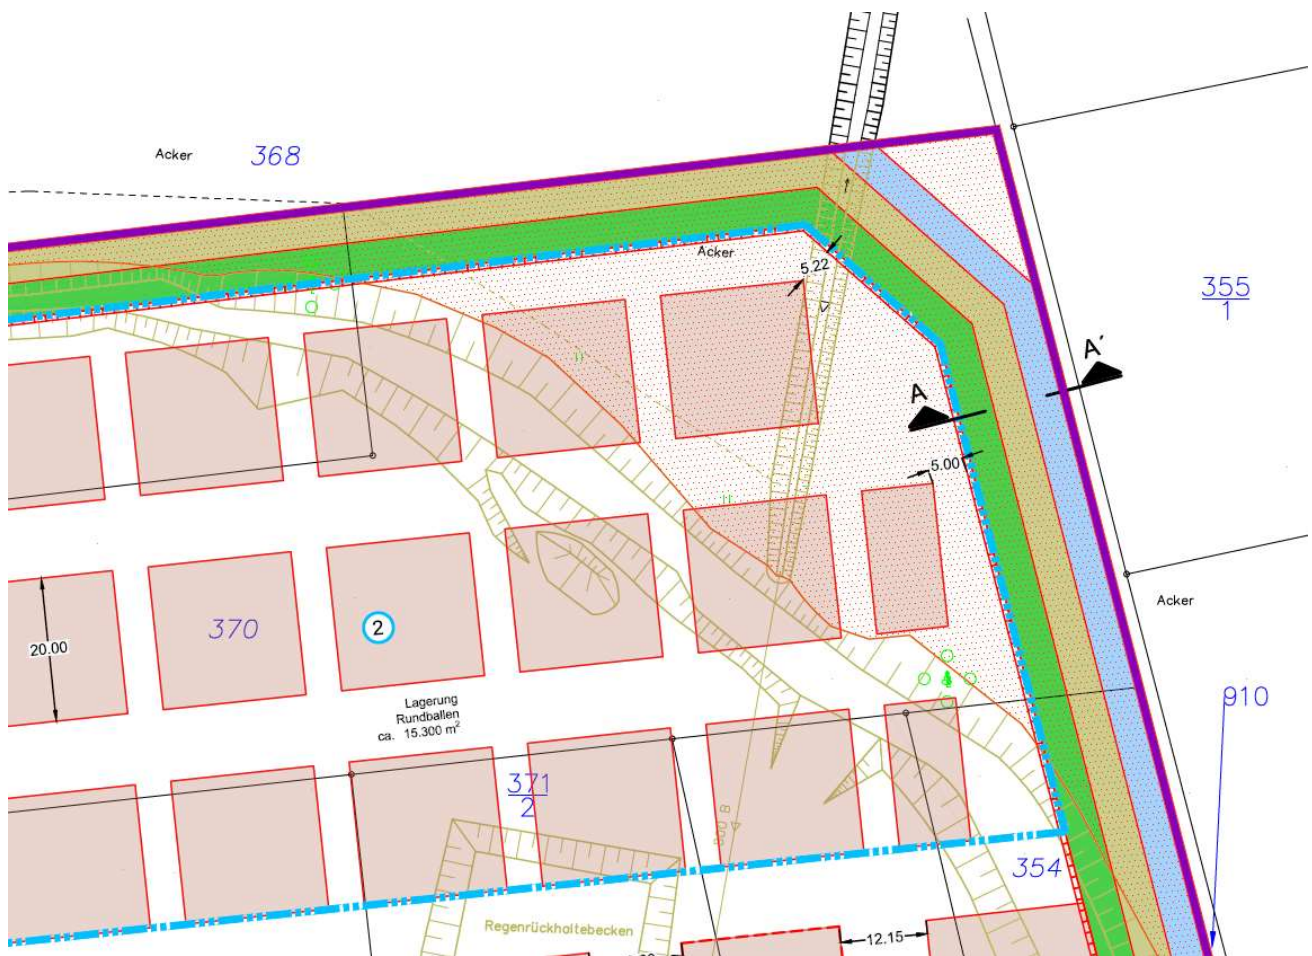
Nordöstliche Ecke des Anlagengrundstücks mit Darstellung Arrondierung (gepunktete Fläche), Abriss bestehender Erdwall (hellgrüne Striche), Neubau offenem Entwässerungsgraben (blau), Neubau Pflegeweg (ocker) und Neuanlage Erdwall/Böschung (grün)
